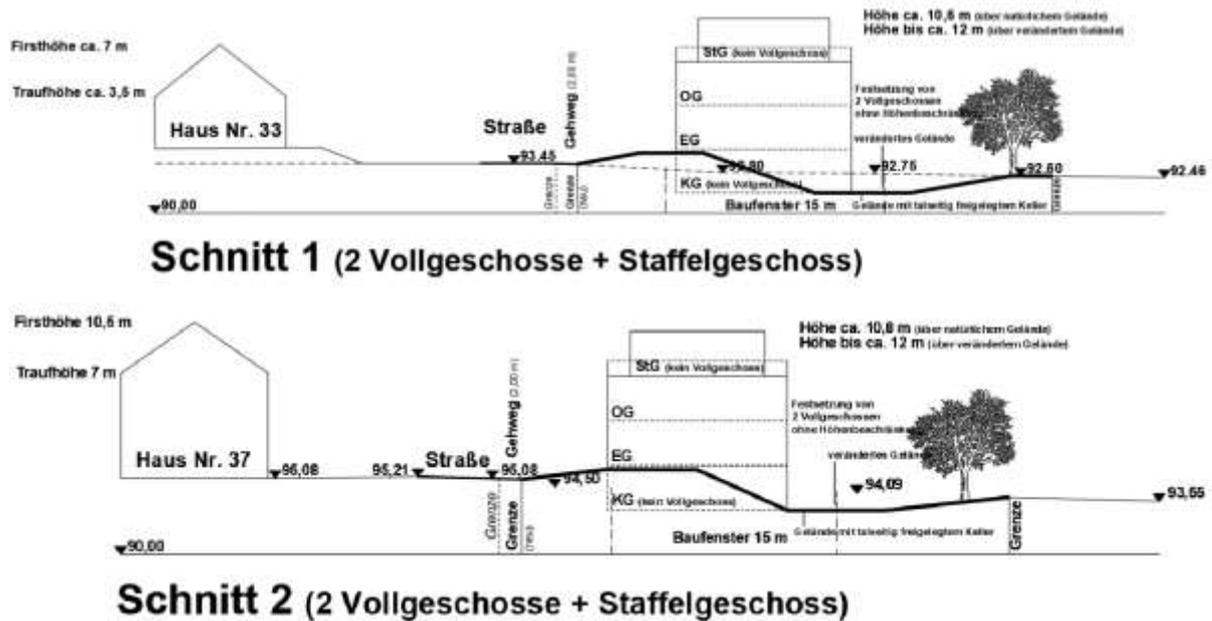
mögliche Bebauung mit Änderung der Satzung
